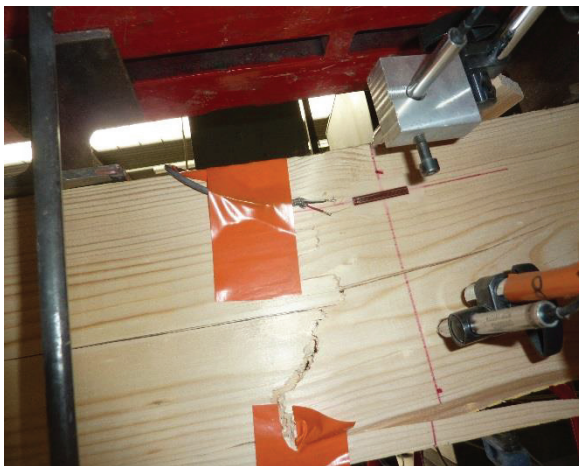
poutre bois Wo7 testée jusqu'à rupture, ruine par traction / cisaillement
